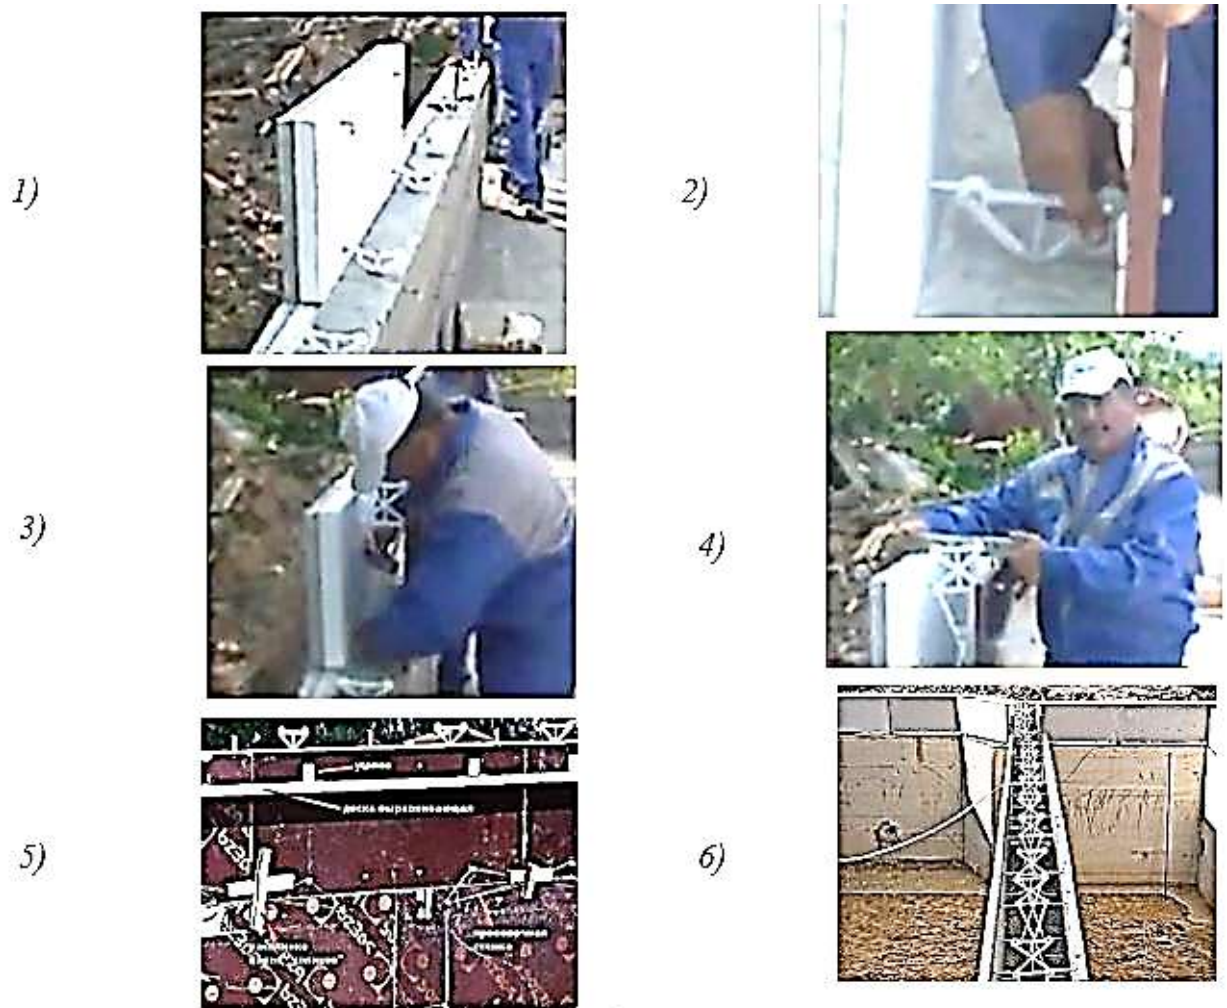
Поетапна установка модулю опалубки з бетонних плит з декоративним покриттям: 1 – установка зовнішньої панелі модуля; 2 – установка пластикової стяжки; 3 – кріплення внутрішньої панелі модуля до пластикової стяжки внизу; 4 – кріплення внутрішньої панелі модуля до пластикової стяжки вгорі; 5 – кріплення двох рядів модуля між собою; 6 – бетонування модулів
